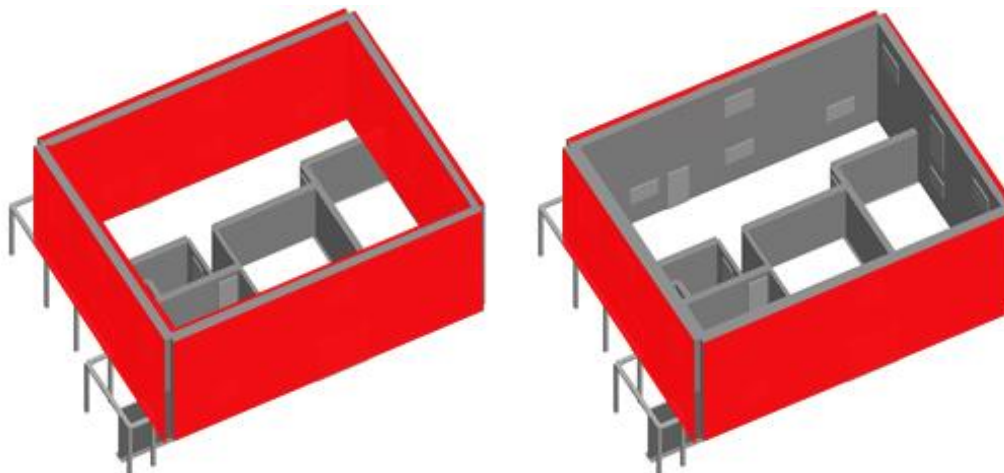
Comparação da execução de reboco armado nas duas faces de todas as fachadas com execução de reboco armado numa face das mesmas fachadas
